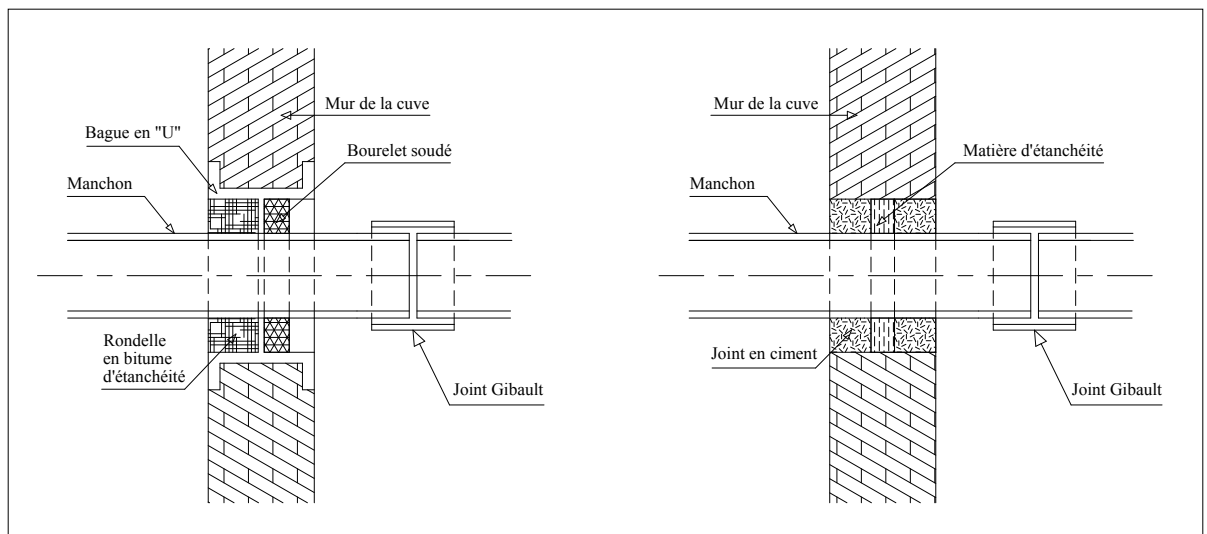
Traversée des conduites (manchon à bout lisse)
